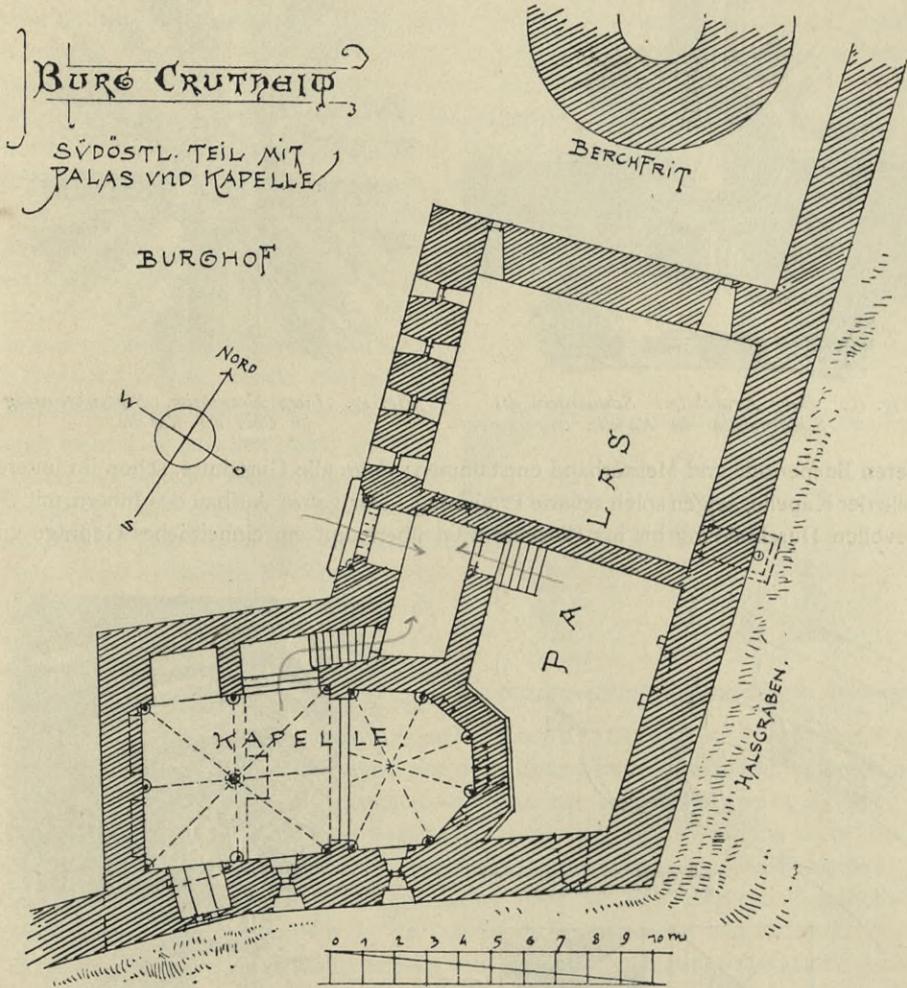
Burg Krautheim. Grundriss von Palas und Kapelle.
